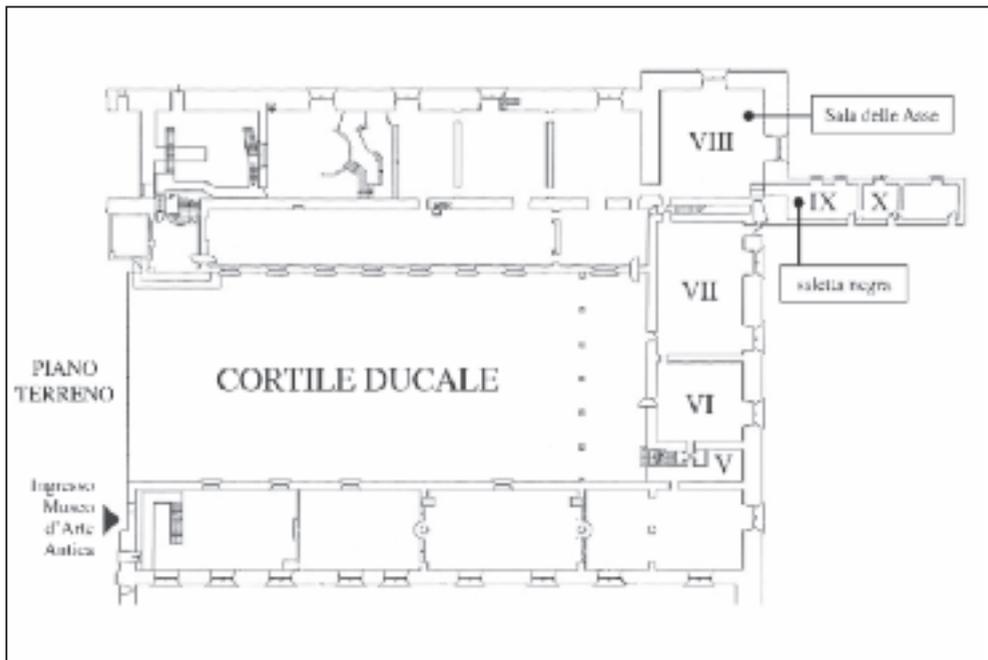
Milano, Castello Sforzesco, pianta della Corte Ducale, piano terreno; disposizione di alcune sale del Museo d'Arte Antica. Ricostruzione grafica di Luca Beretta
